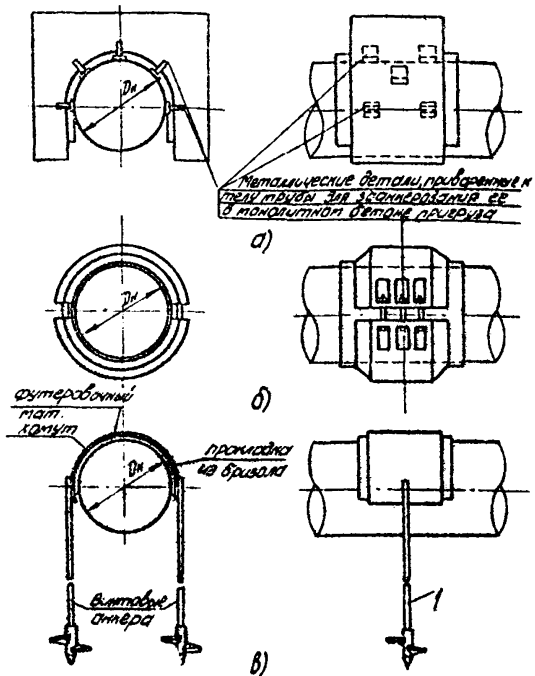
Отдельные типы пригрузов и анкеров, используемых при закреплении трубопроводов
